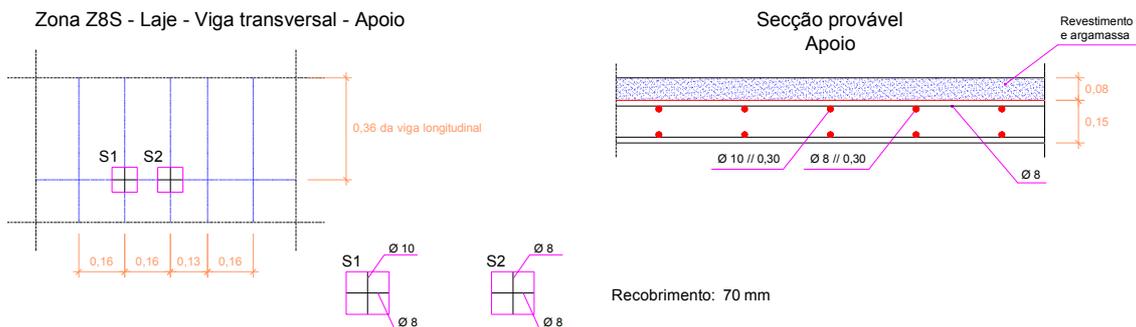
Disposição da malha de armaduras levantada com o pacómetro e secção provável da laje sondada.
